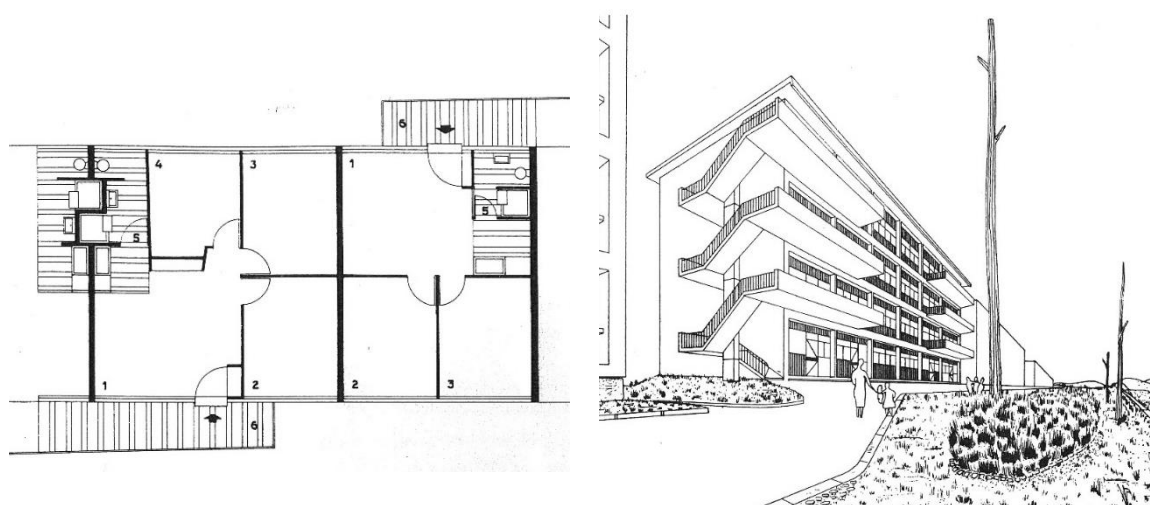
Solução B do Plano de Salubridade das “ilhas” do Porto, desenhos de Almeida d’Eça. Fonte: CMP, 1956.
